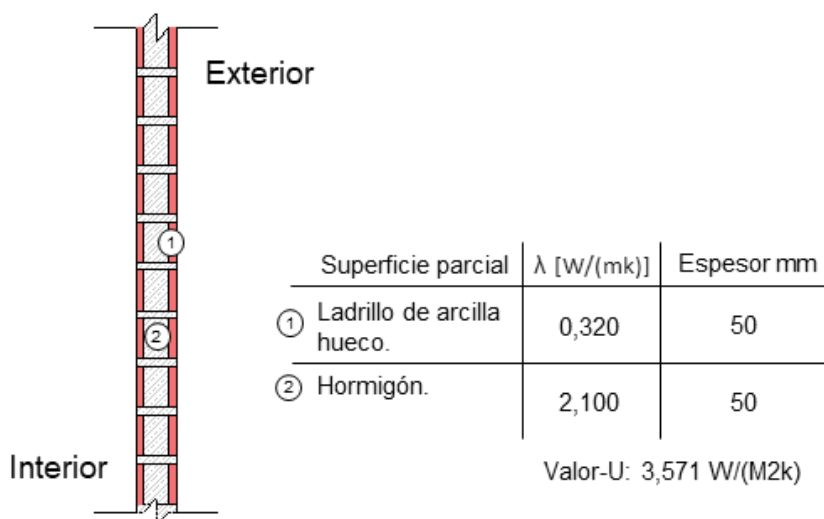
Detalle de elemento constructivo de muro de fachada. Fuente: elaboración propia.
